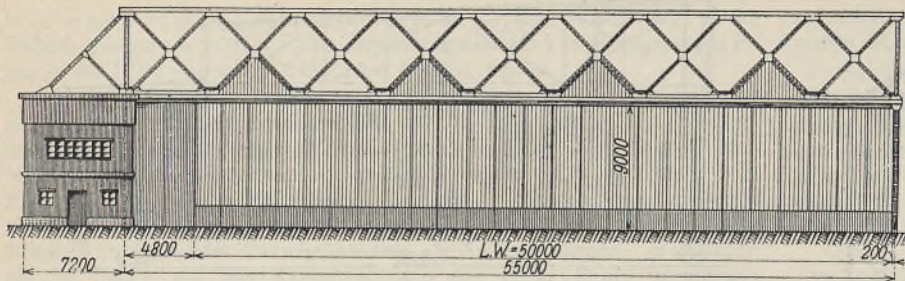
Vorderansicht mit geschlossenen Toren.
